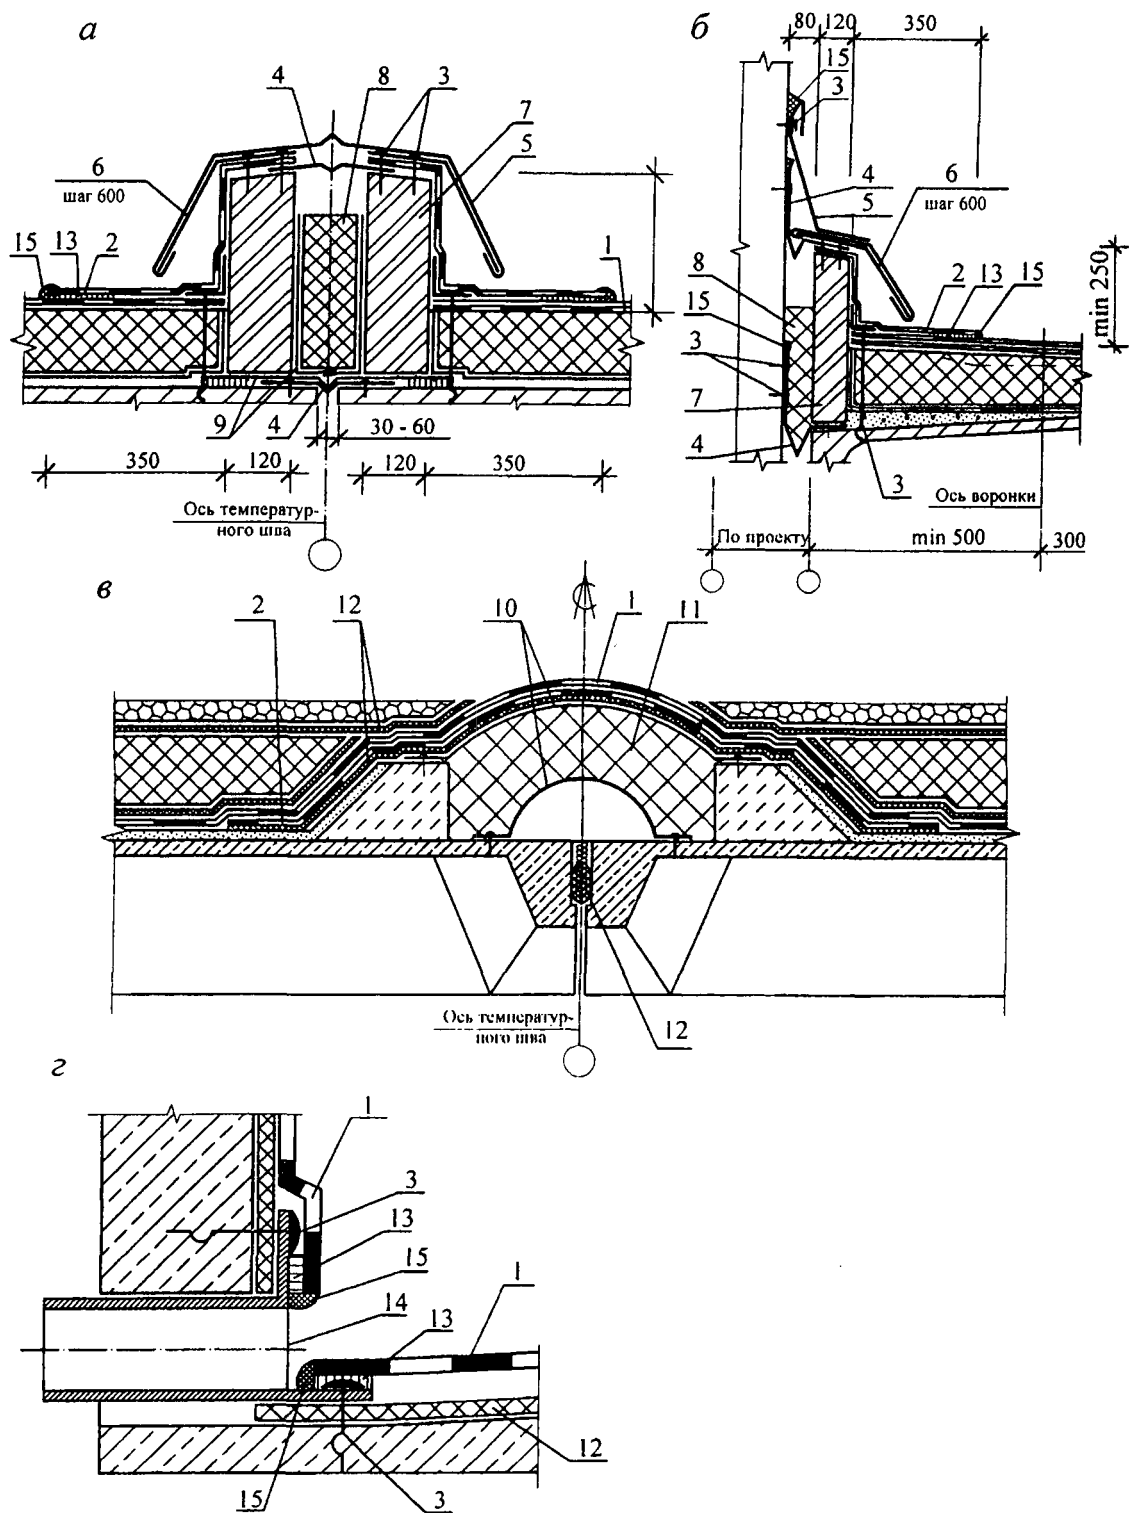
Устройство мембранной кровли по покрытию из железобетонных плит:
